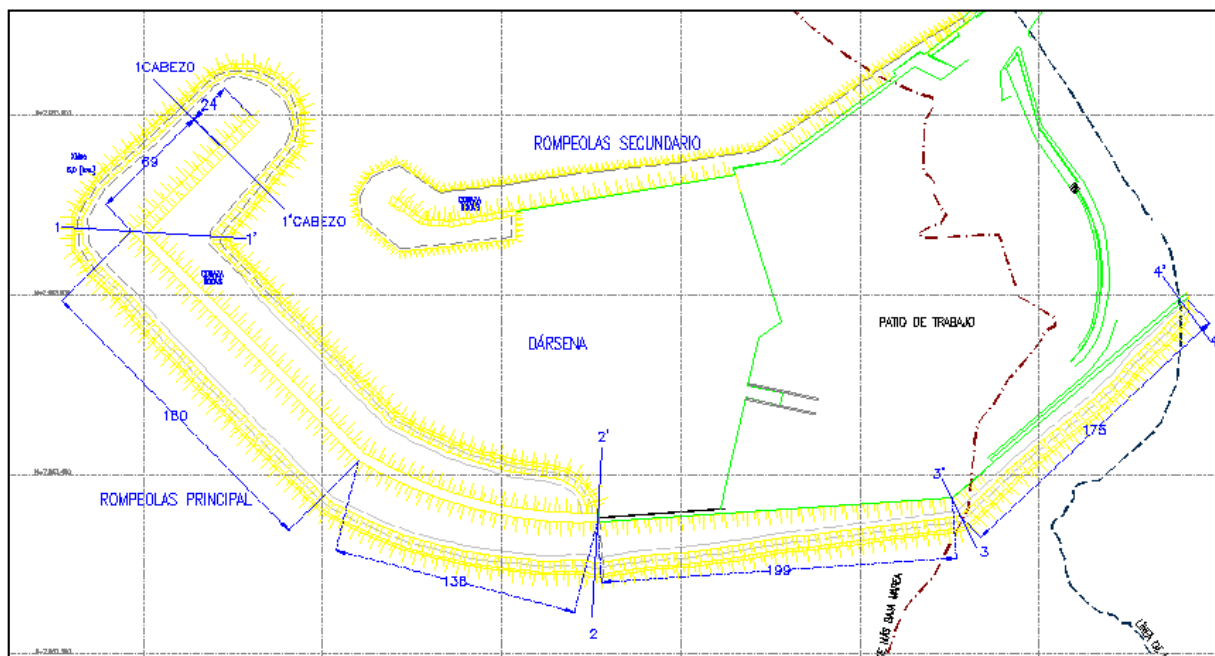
Planta Layout Rompeolas y dársena proyectada.
